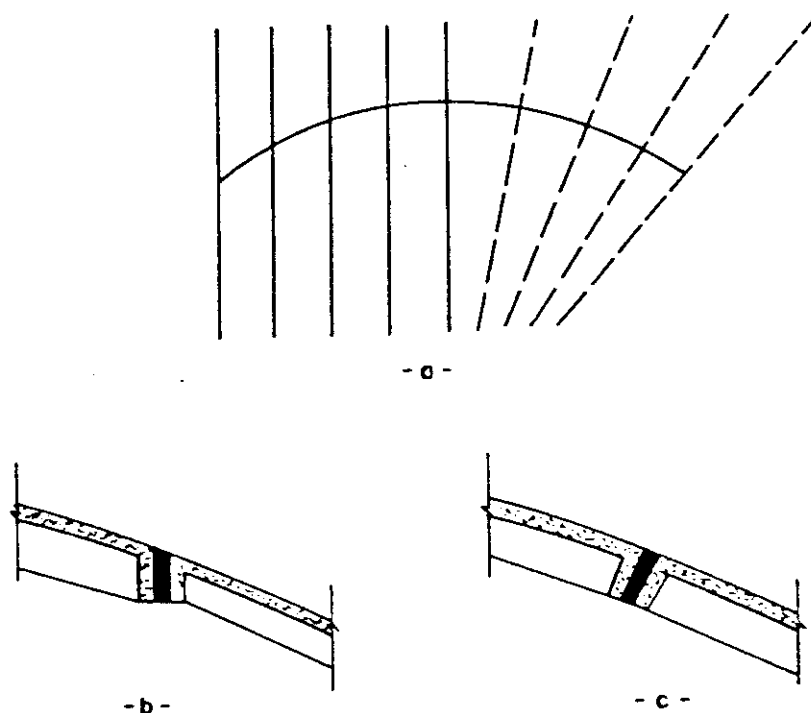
a - seccionamento da superfície por planos verticais e radiais
